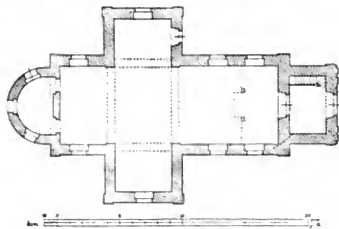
Obecnitz. Grundriss der Kirche.
